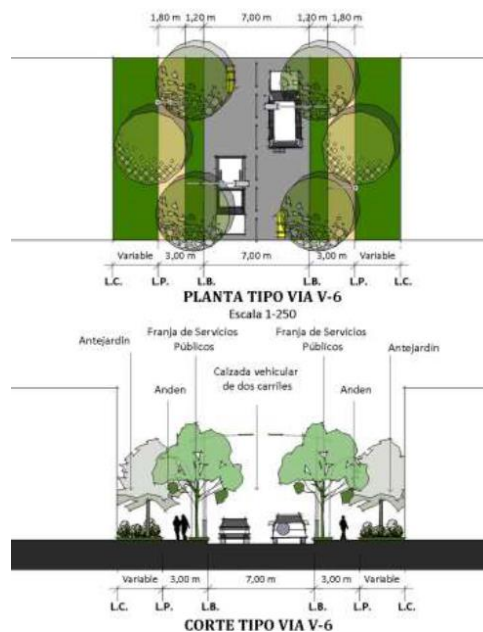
Planta y Alzado de una vía V6.Fuente: POT barranquilla, Anexo 6 perfiles viales.
